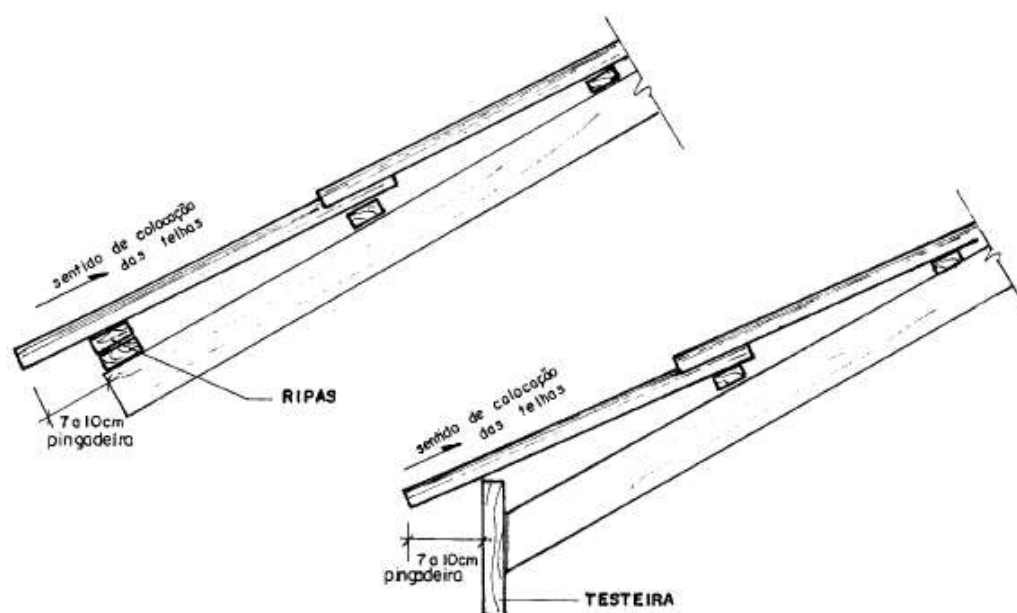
Detalhe da colocação da primeira ripa ou testeira.
